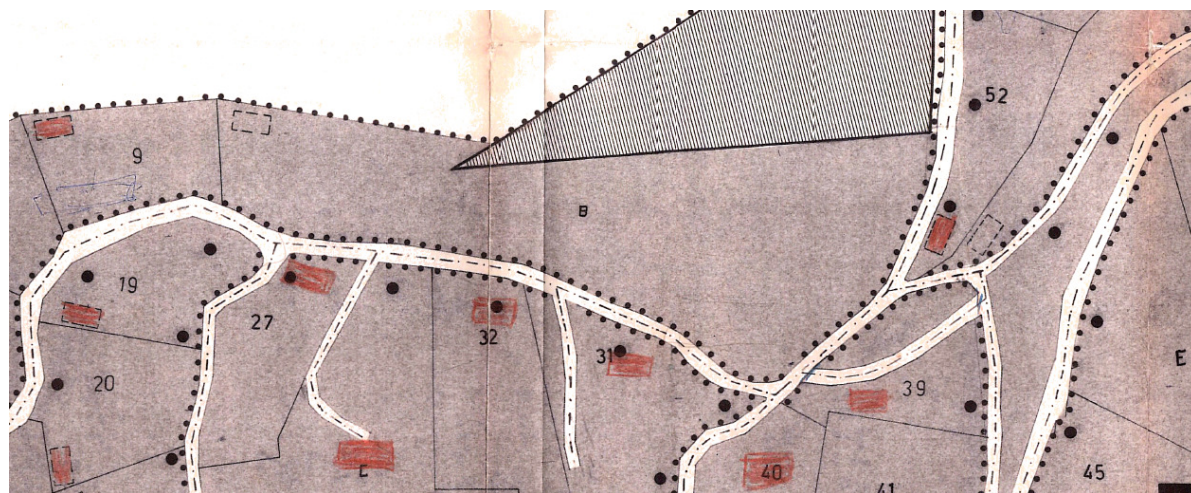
Stralcio della Tav 4 del Piano di Lottizzazione ex D.A. 518 del 18.07.74;
